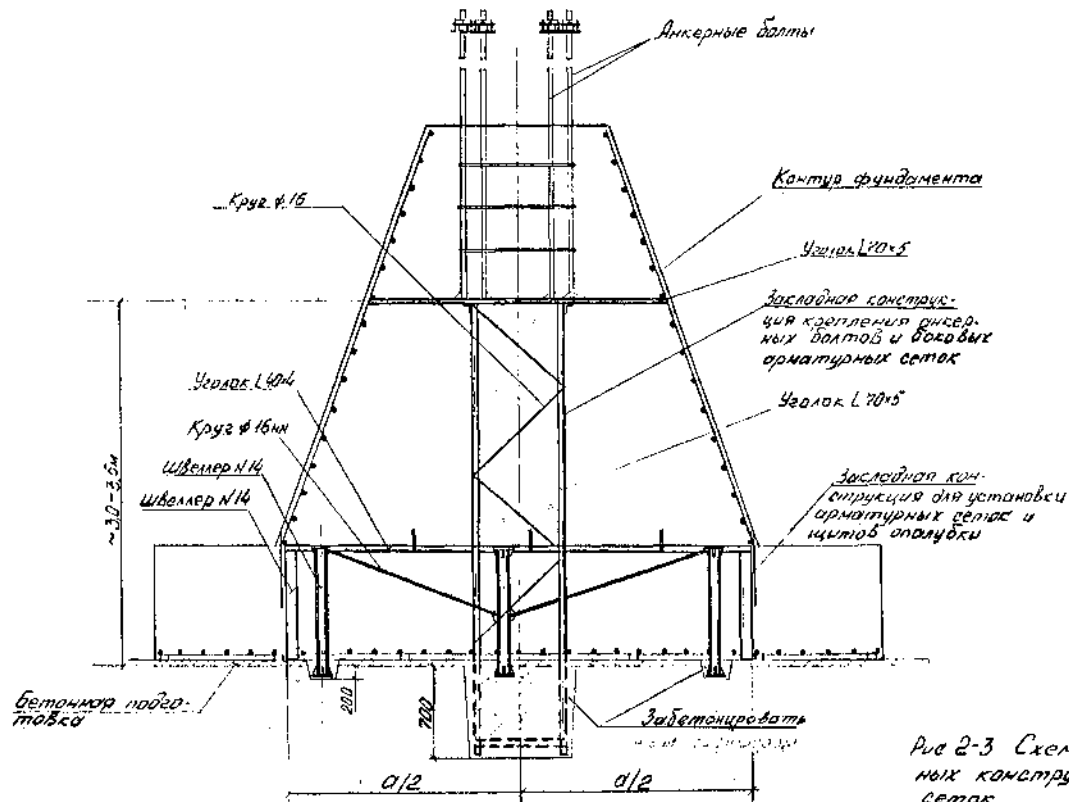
Схема установки закладных конструкций и арматурных сеток
